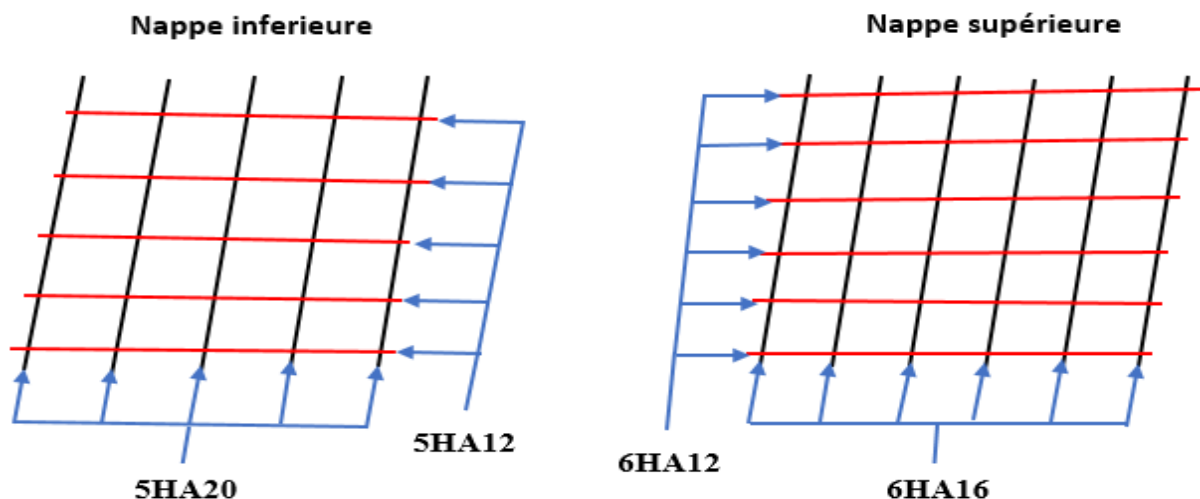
VUE EN PLAN DU FERRAILLAGE DE LA DALLE
